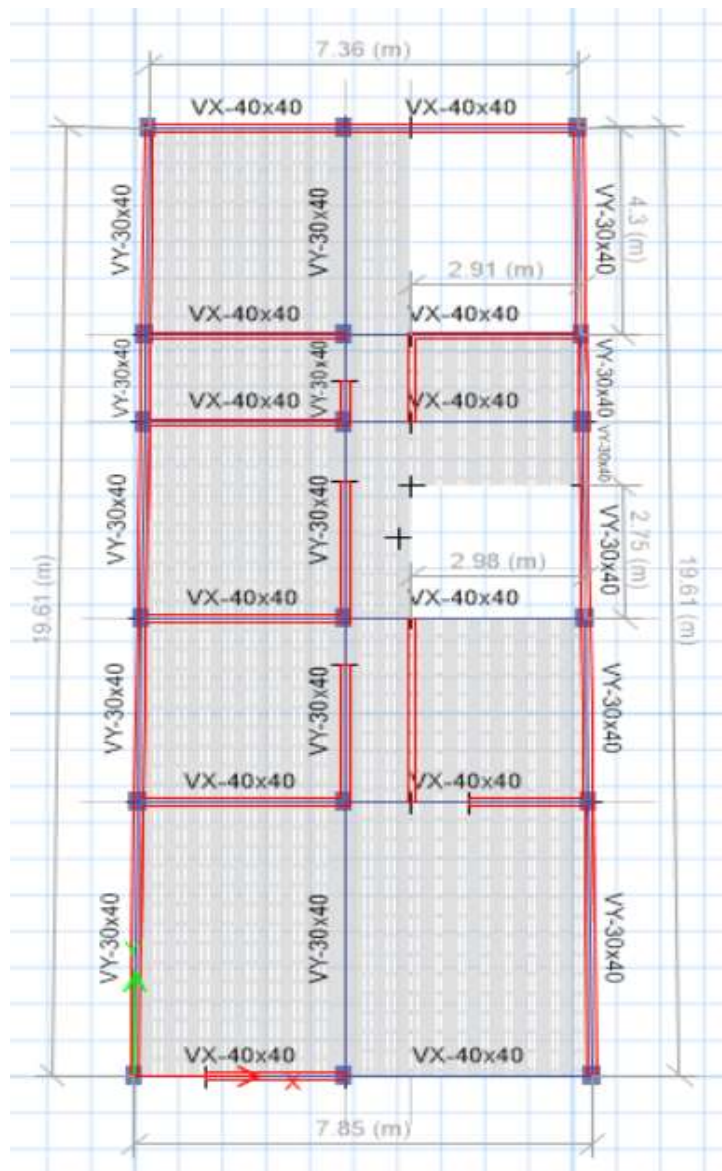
Estructuración en planta en Etabs de la vivienda N°03
